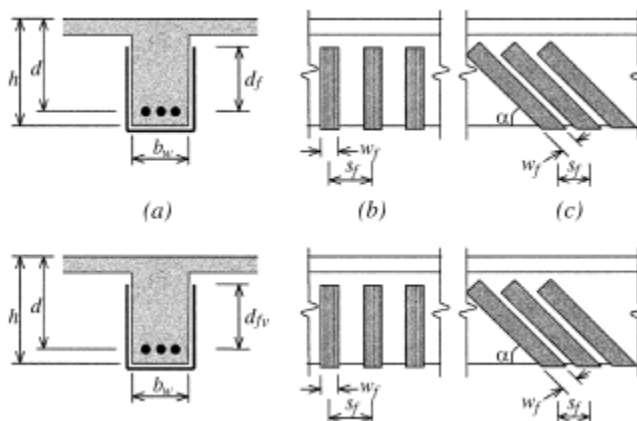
Disposición del reforzamiento recomendado por el ACI 440- 2R-17.[13]
